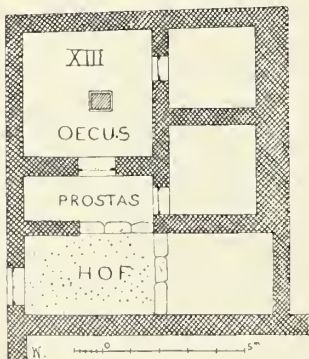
Grundriss des Hauses Nr. XIII.
